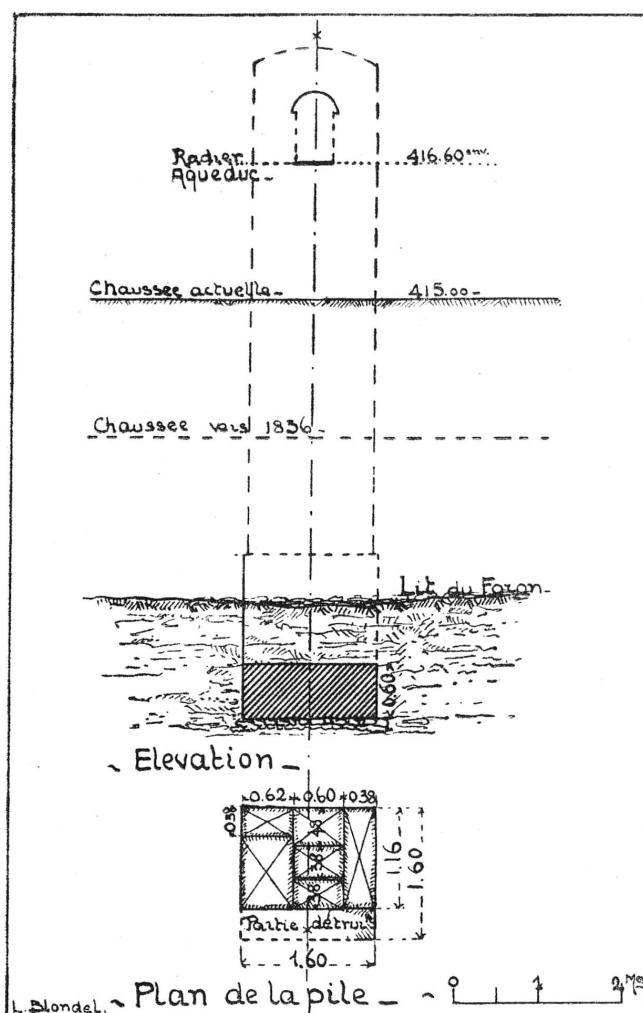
Plan et élévation de la pile du pont-aqueduc sur le Foron.
